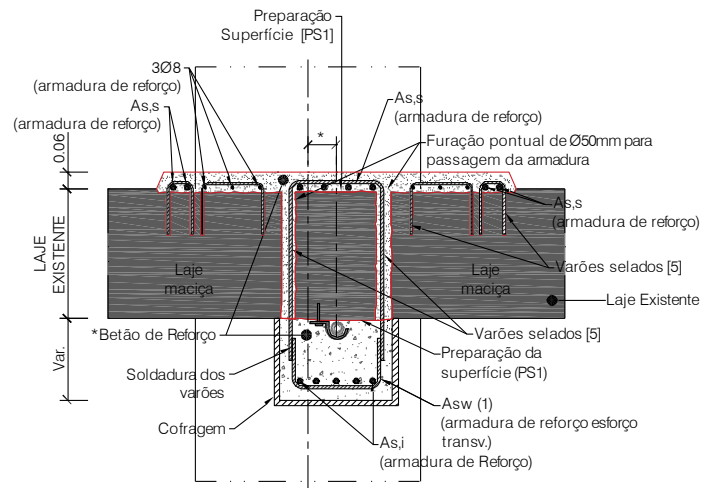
Pormenor tipo da viga de reforço em zona maciça da laje.
